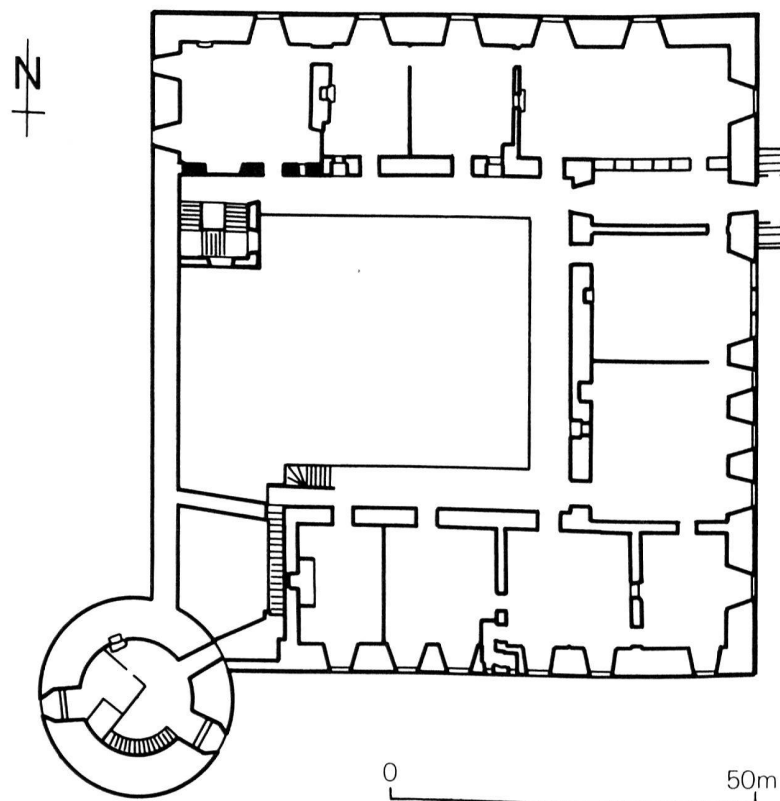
Bulle/Château. Plan du château, 1^{er} étage d'après plan de 1899 in «Fribourg artistique à travers les âges» (1:1000)
